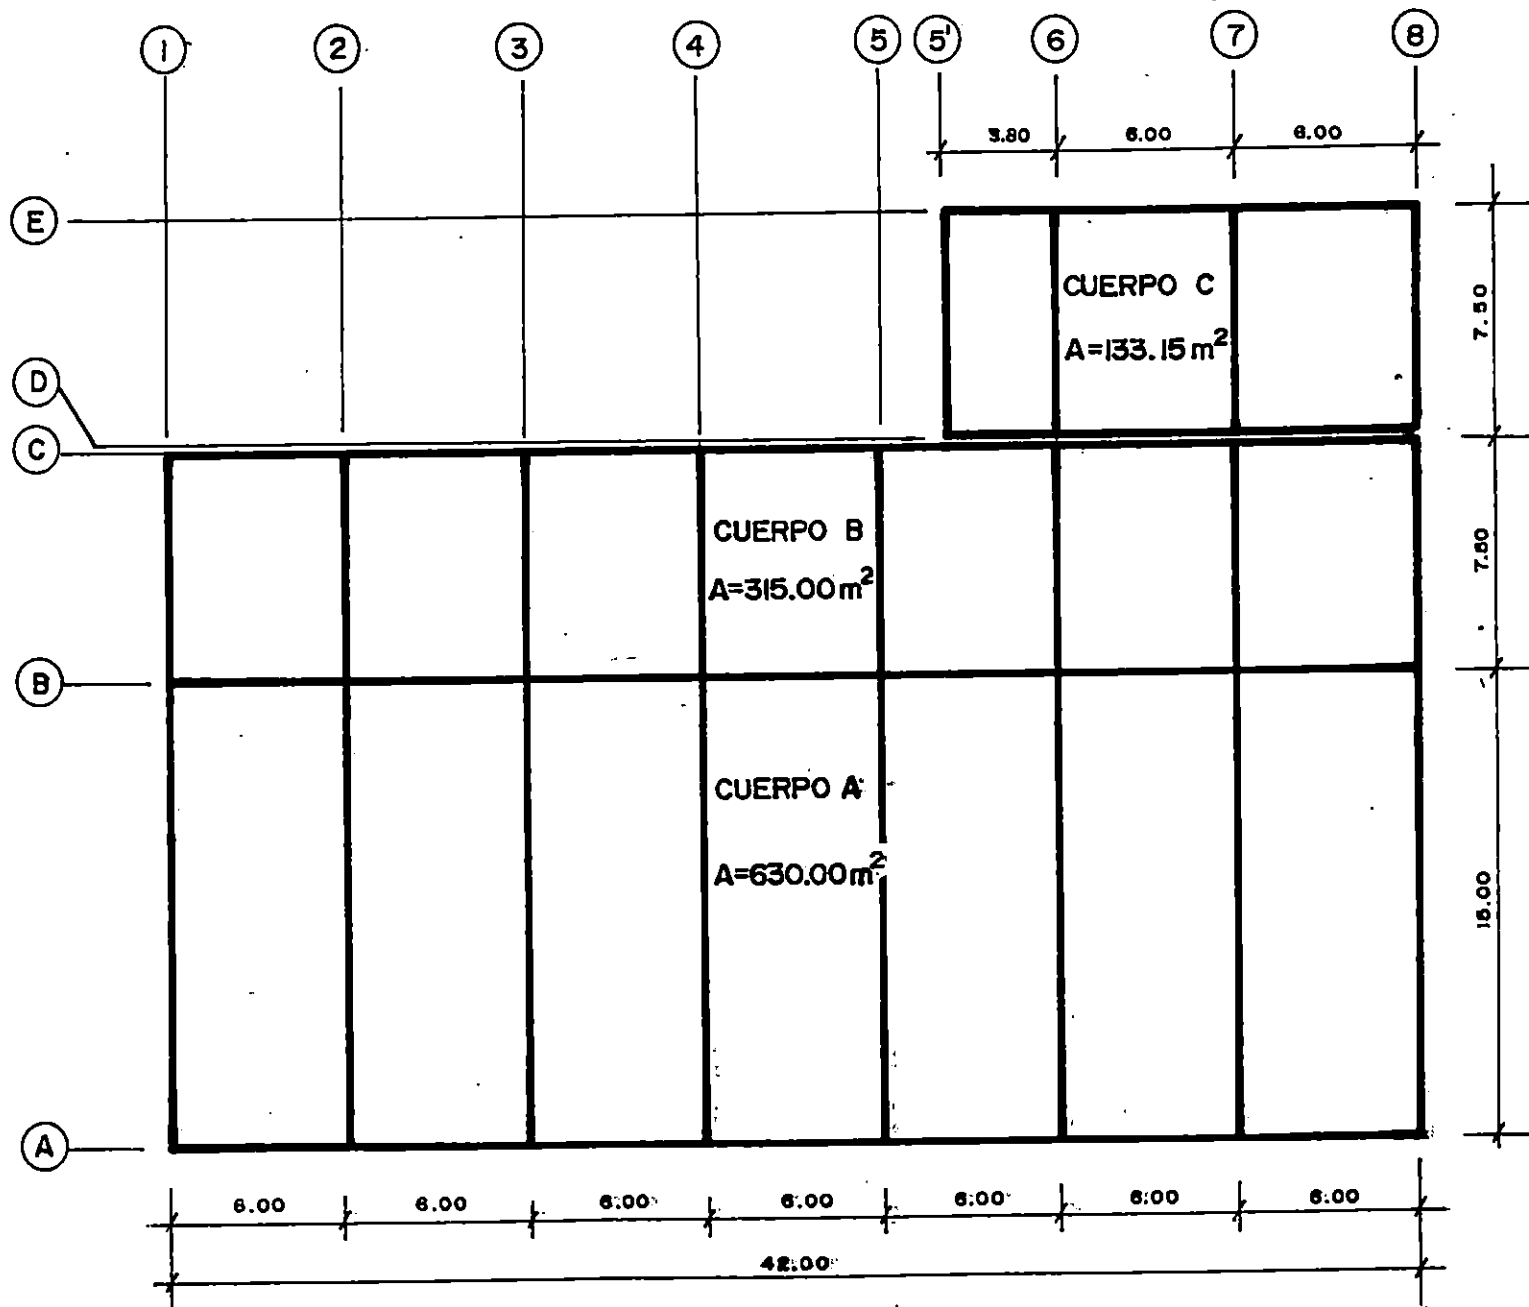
DISTRIBUCION EN PLANTA DEL EDIFICIO DE INGENIERIA MECANICA
